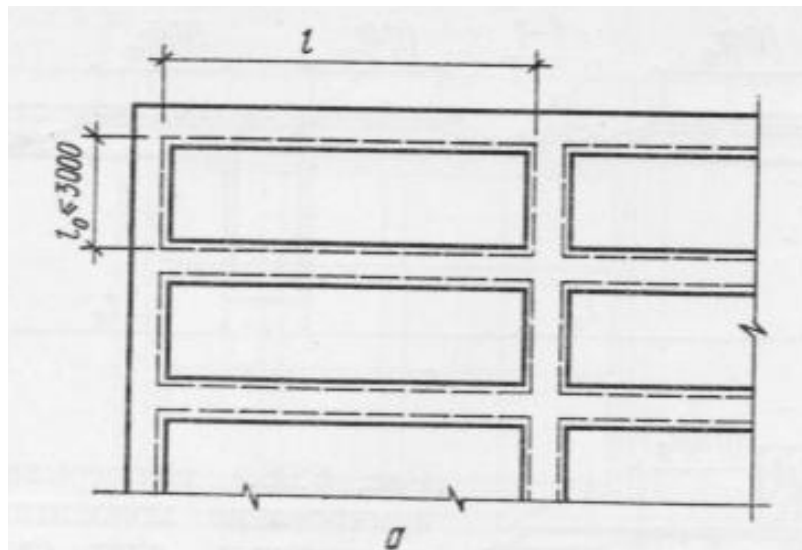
Схема армирования монолитных балочных плит сварными сетками:
